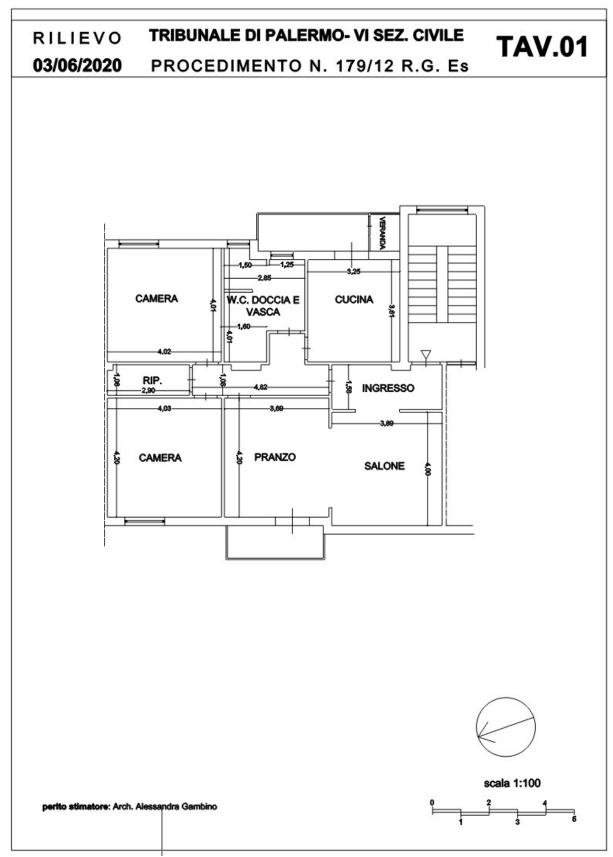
planimetria dell'immobile- rilievo del 03/06/2020
